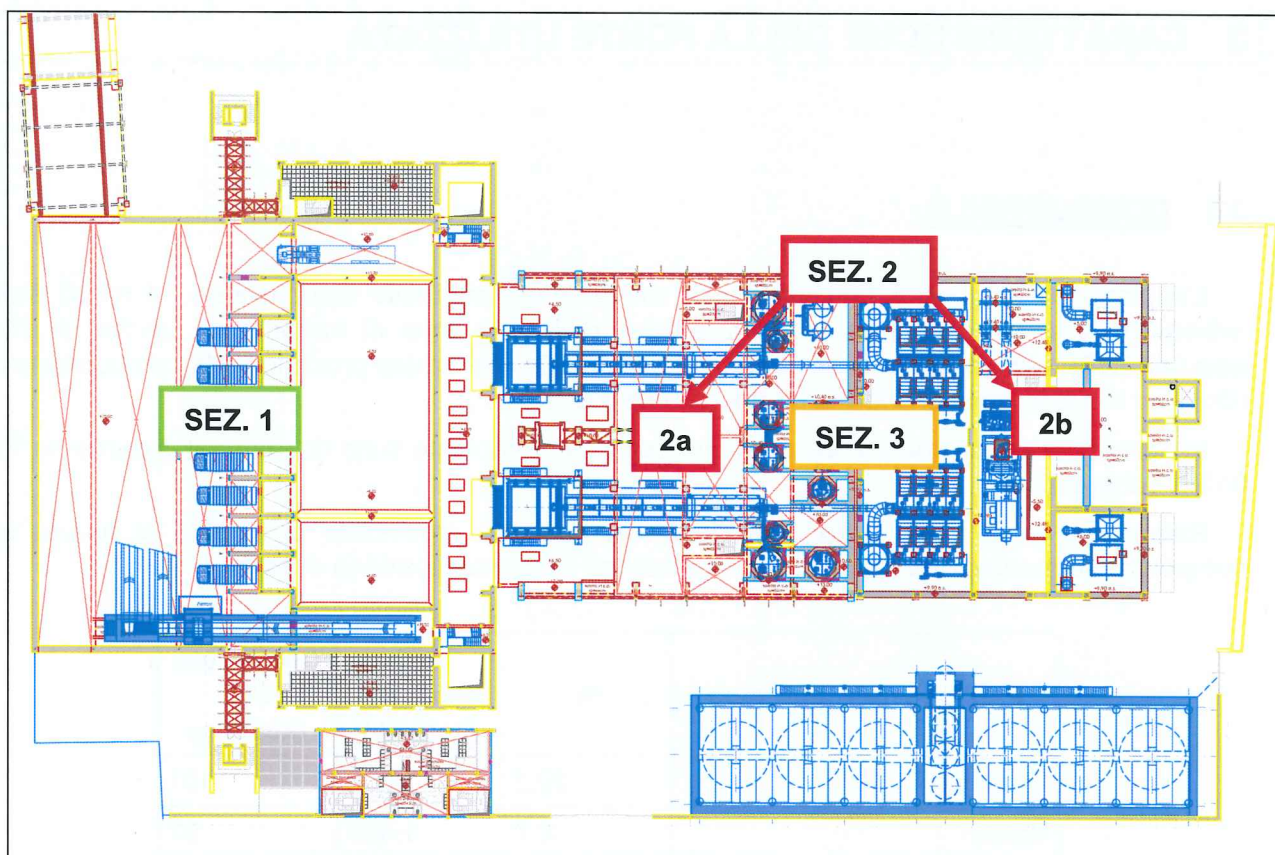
Layout impianto con indicazione delle principali sezioni impiantistiche
